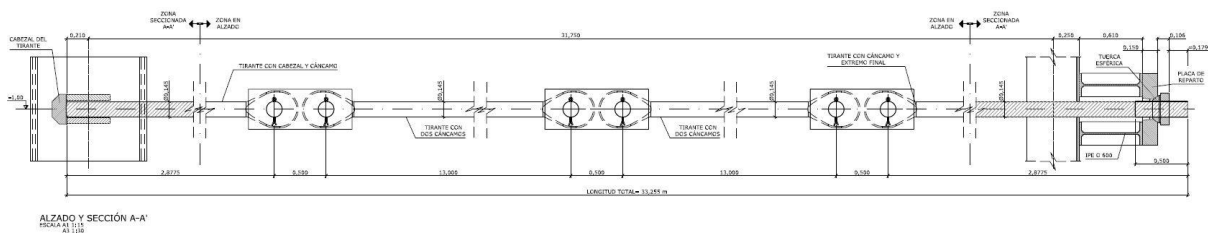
Alzado de los tirantes de la Sección tipo 1
